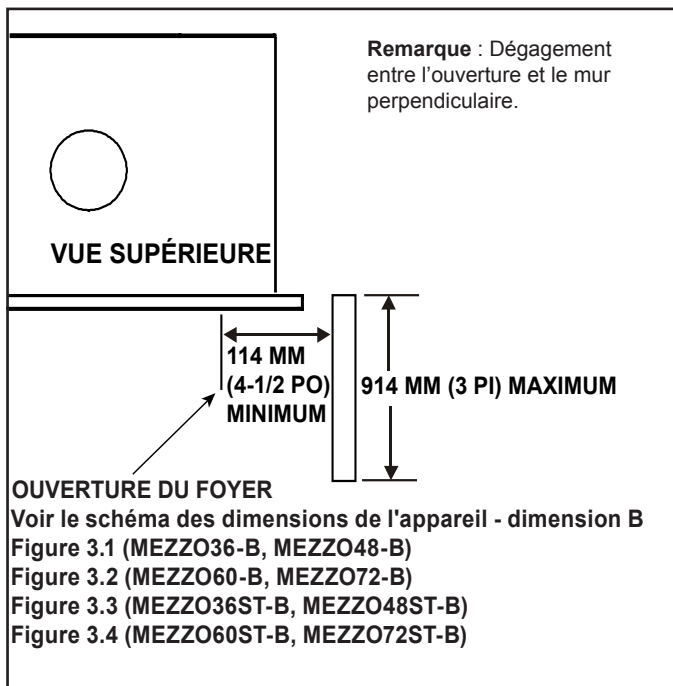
Saillies des pieds du manteau de foyer ou du mur
